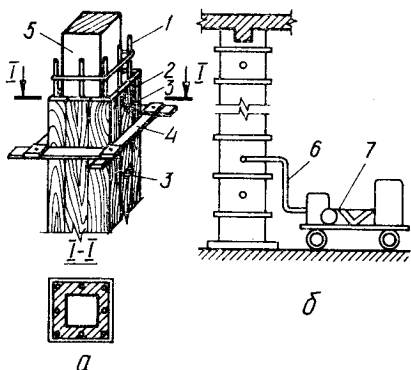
Схема усиления колонны железобетонной обоймой:
